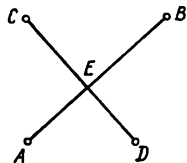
Схема переноса в натуру проекта небольшой наклонной площадки путем одной установки нивелира.
